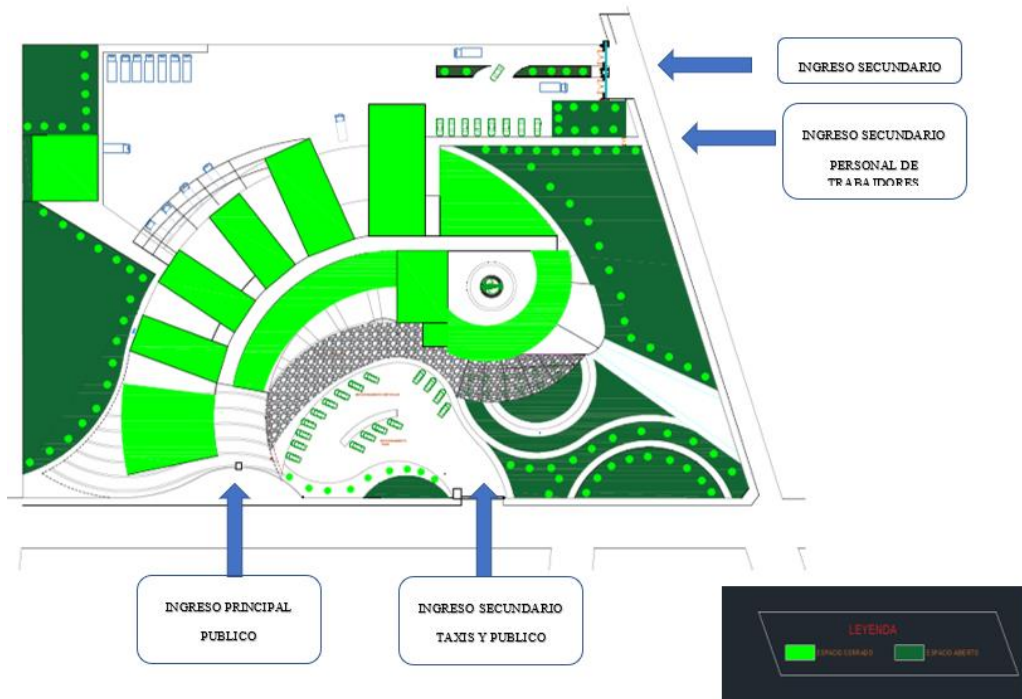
Plano general - Sistema de espacios abiertos y cerrados.
